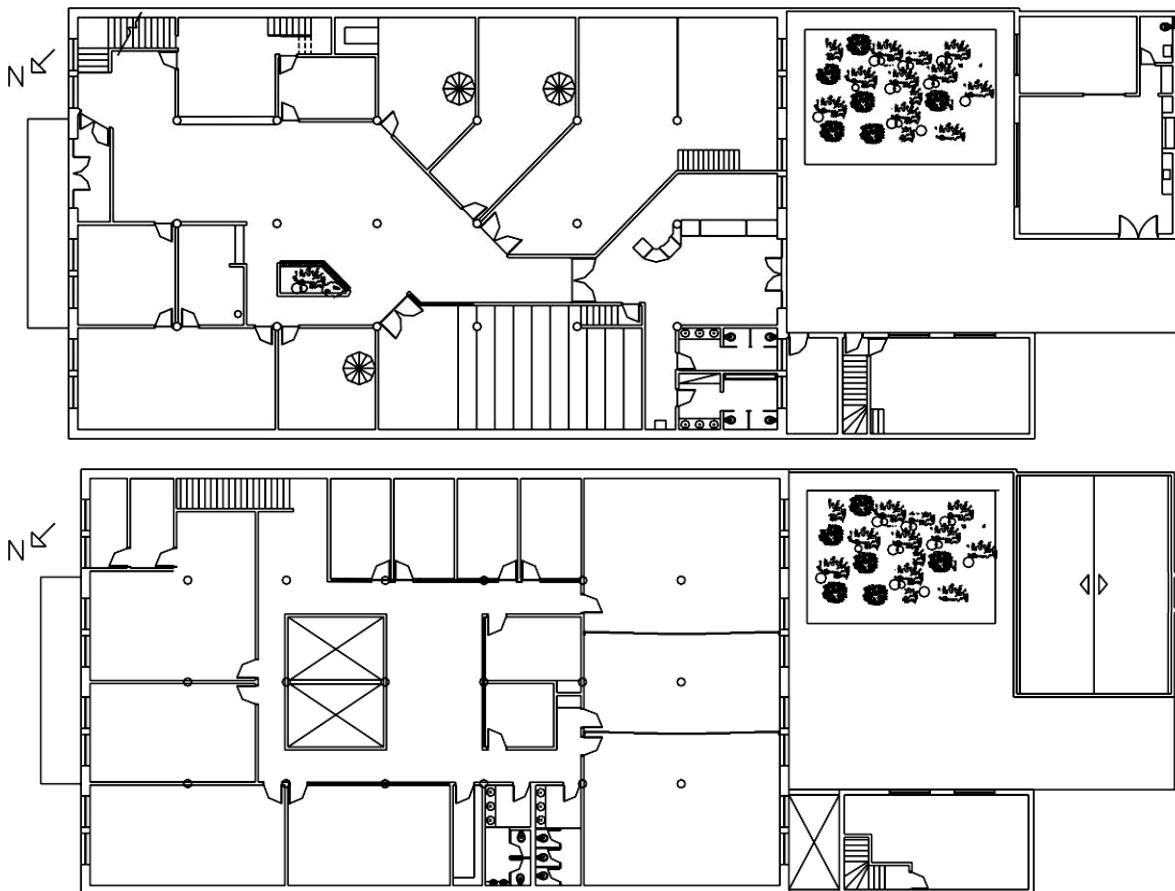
Plantas Baixas dos Pavimentos Térreo e Superior da FAUrb
